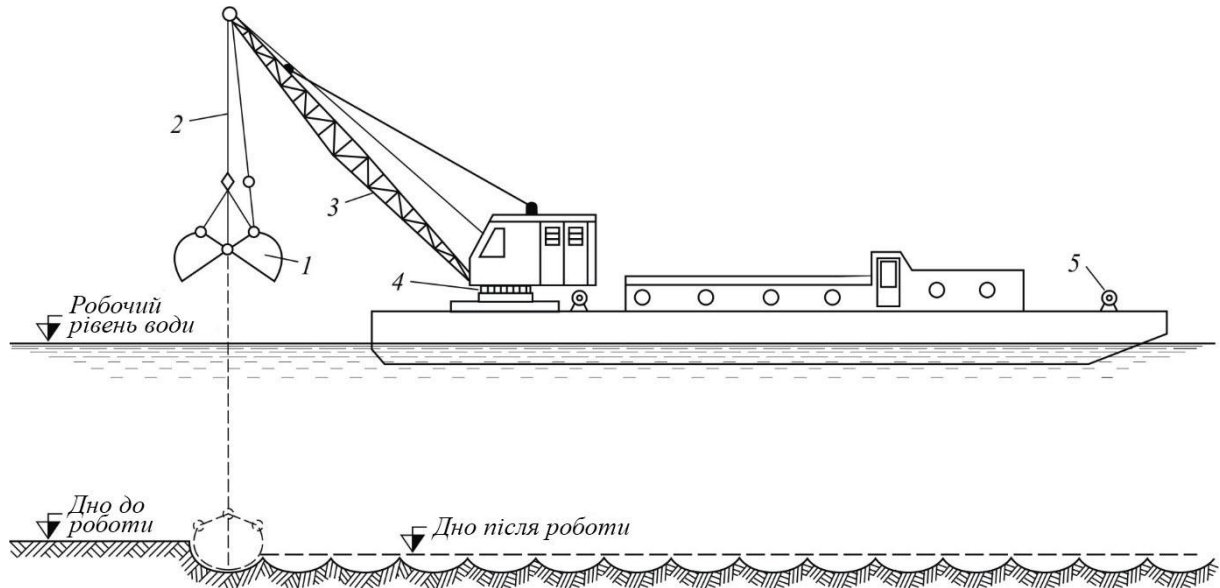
Схема роботи грейферного земснаряду: 1 – ківш; 2 трос; 3 – стріла; 4 – поворотний механізм; 5 – лебідка
